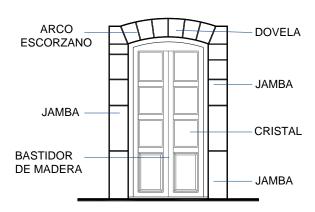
Vista de la puerta de acceso de la cocina - comedor (1) de la vivienda
